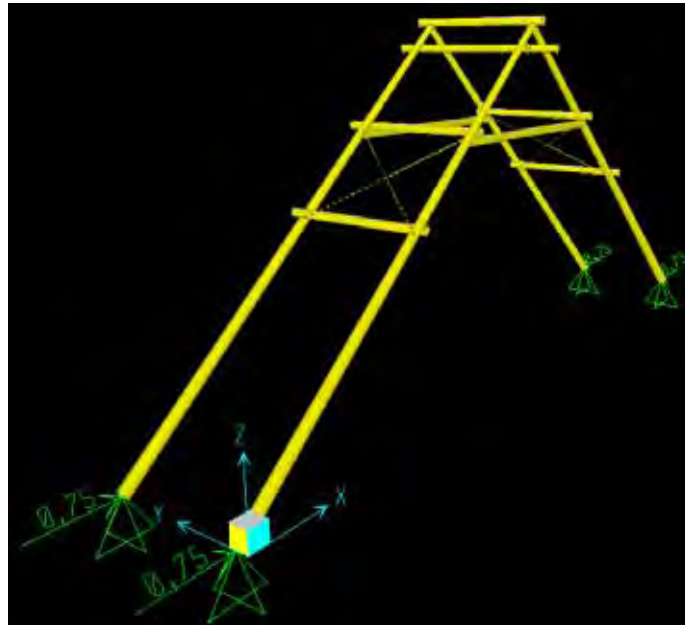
Vista tridimensional da aplicação do deslocamento na base do pórtico
